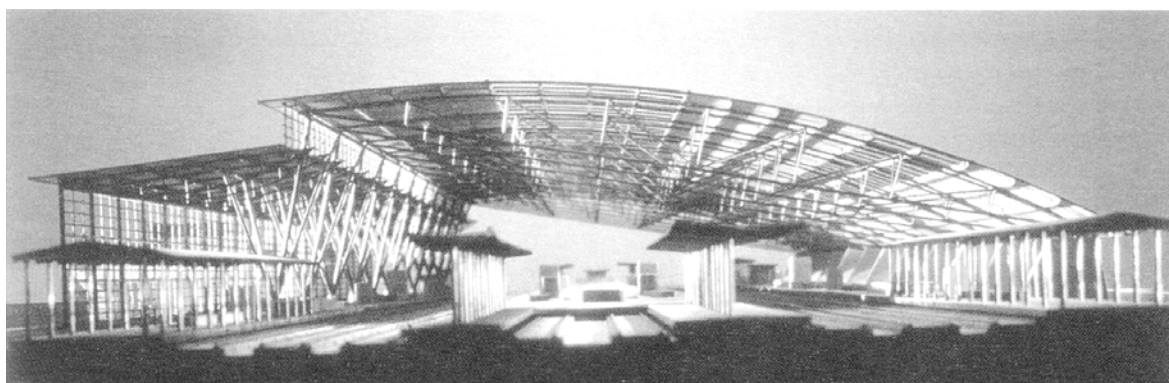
Modellfoto der neuen Erfurter Bahnhofshalle
